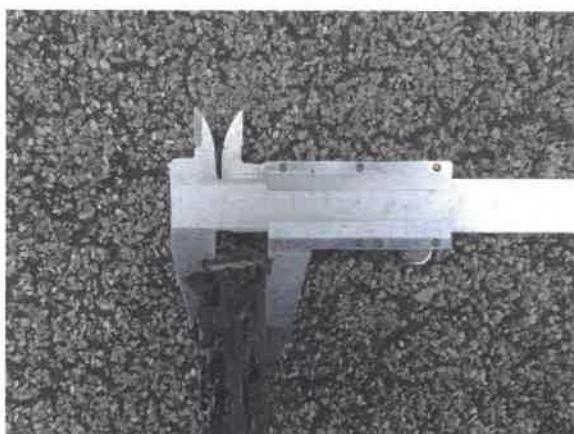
až 8 – Sonda ST2 – Pohledy do sondy
